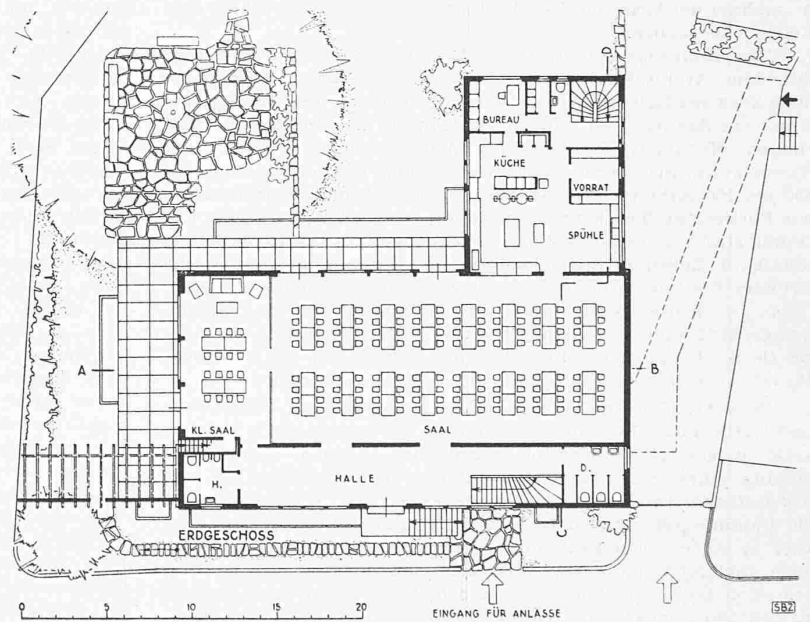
Grundriss vom Saalgeschoss mit Küchenflügel. — 1 : 400
